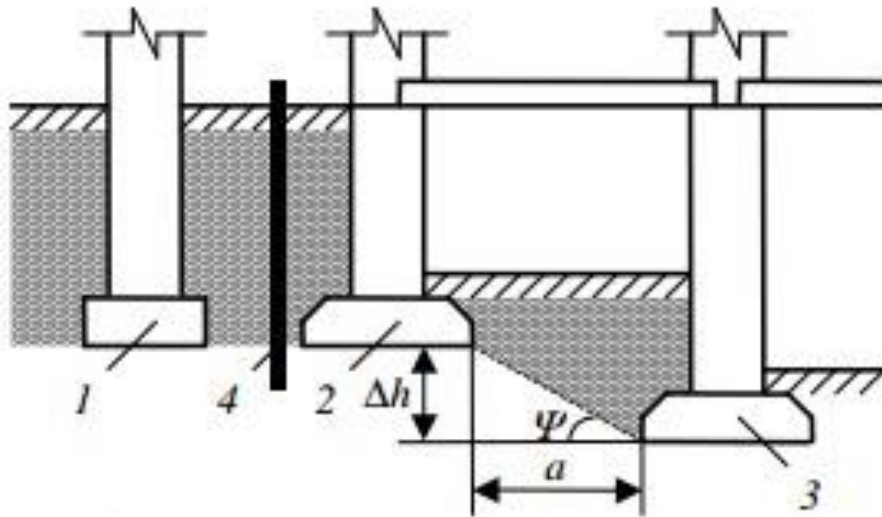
Схема захисту існуючої будівлі від додаткових осідань при зведенні поряд нової будівлі з більшою глибиною закладання фундаментів:
